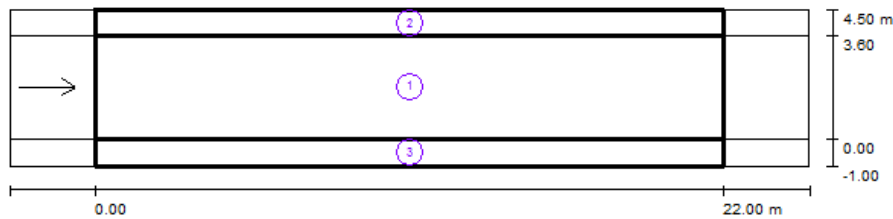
resumen luminotécnico de la calle Pilar Cavero.
